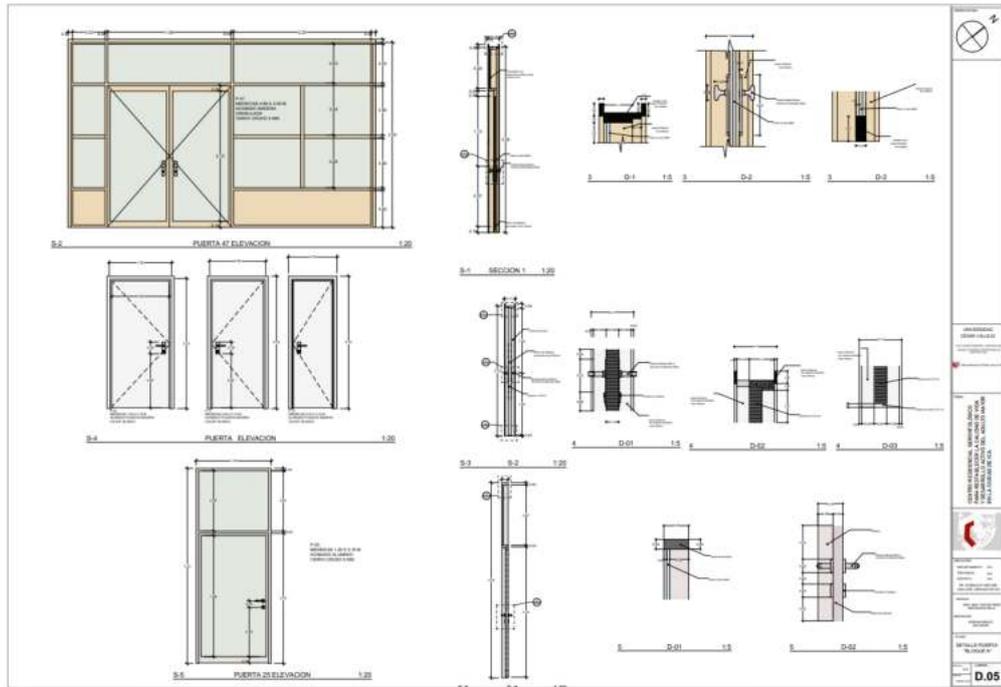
Plano detalles arquitectónicos de vanos (puertas).
